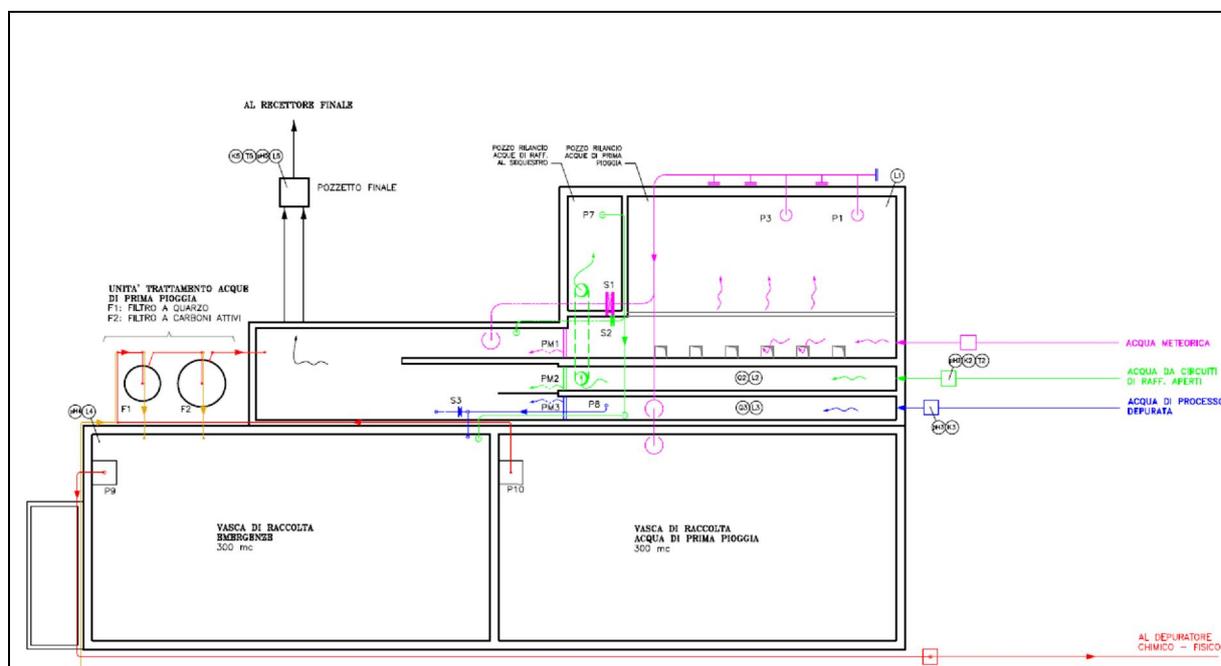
Planimetria delle vasche di raccolta delle acque meteoriche
